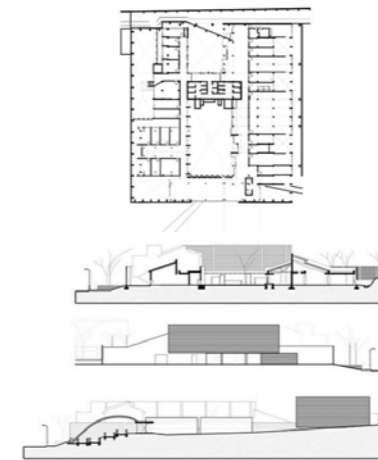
Planta, Corte y Alzado La Teletón/ Fuente:Análisis de las Características Estructurales en la Obra del Gabinete de Arquitectura y Propuesta Arquitectónica
